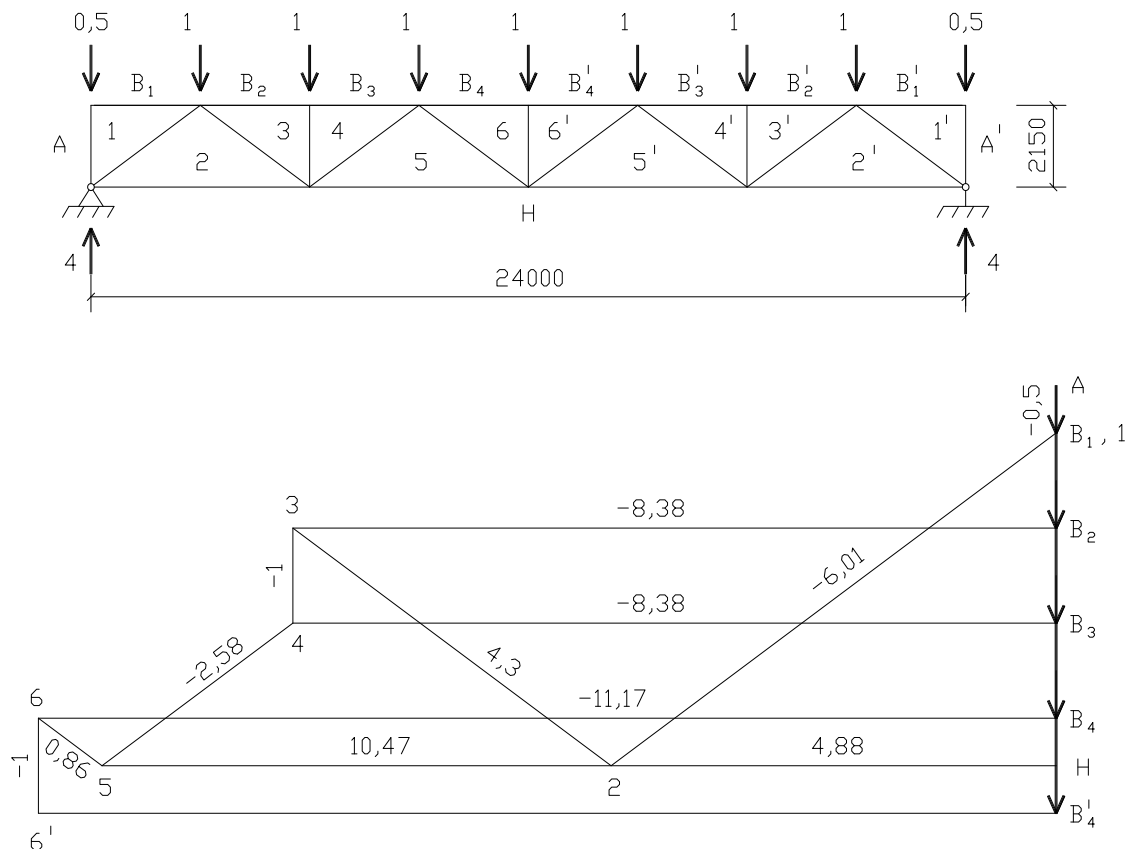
Расчетная схема фермы пролетом 24 м и диаграмма усилий от единичной нагрузки
